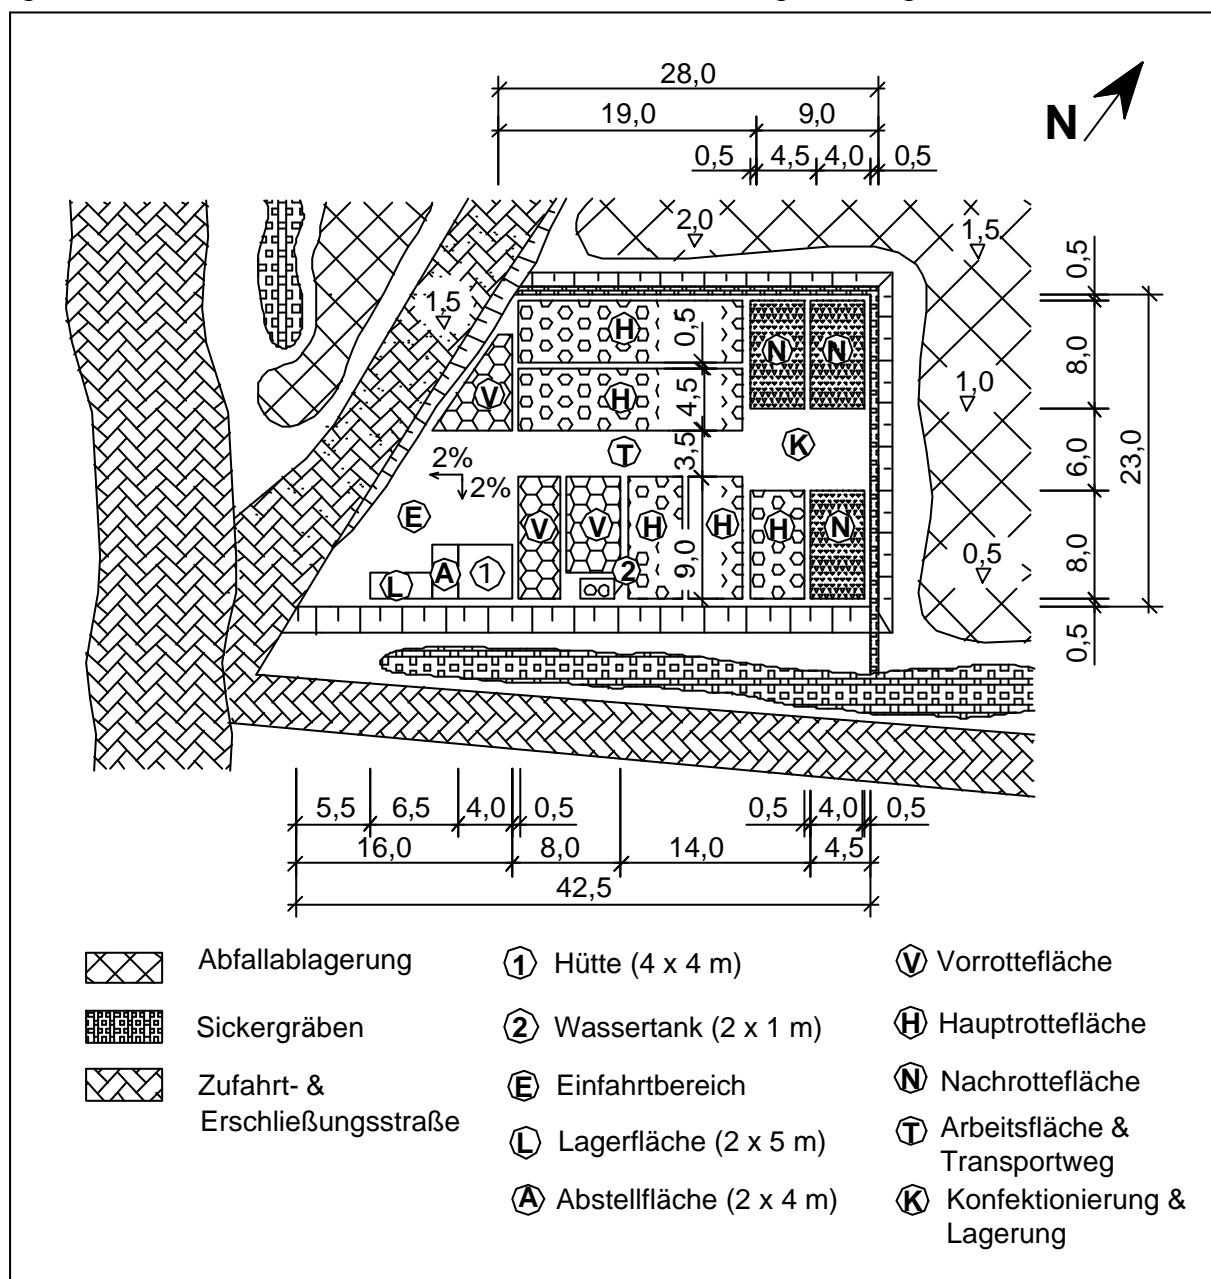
Grundriss der KOSA mit Flächeneinteilung (nach den Straßenbaumaßnahmen)
